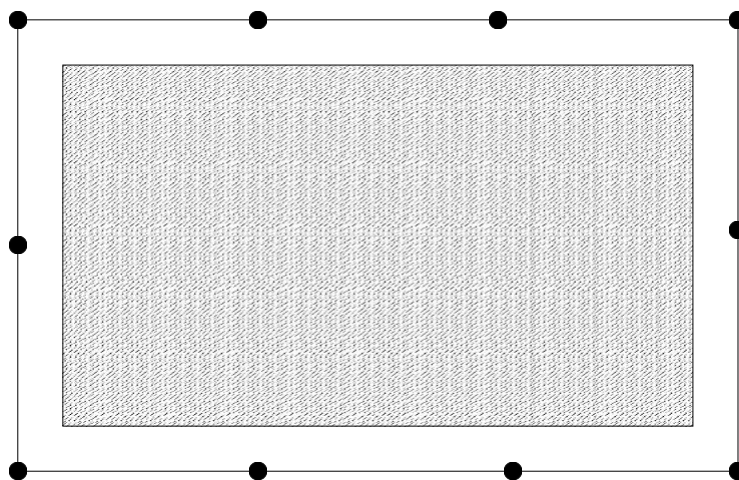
Розташування контуру заземлювального пристрою
